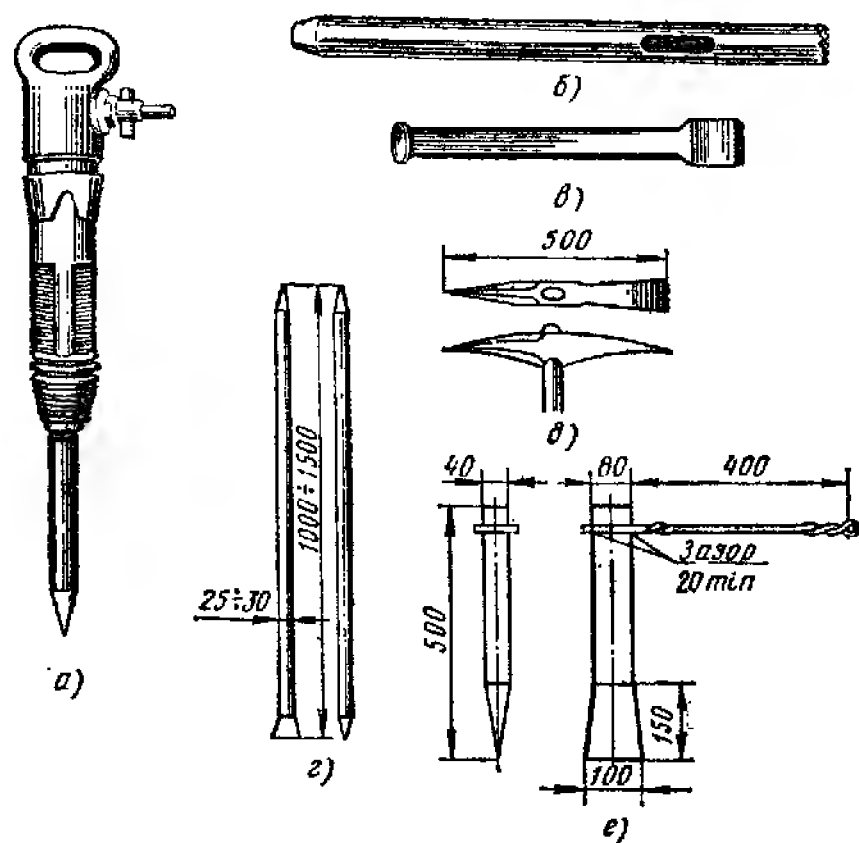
Инструменты для пробивки отверстий и разборки кладки:
